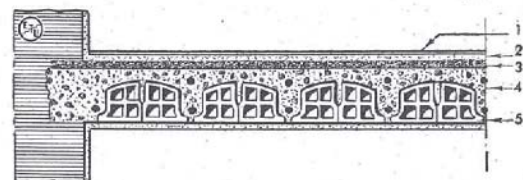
SOLAIO "MIOZZO SALERNI". - 1 Pavimento - 2 Lastre isolanti - 3 Sotlofondo - 4 Gettata in calcestruzzo di cemento - 5 Foraloni in laterizio.
